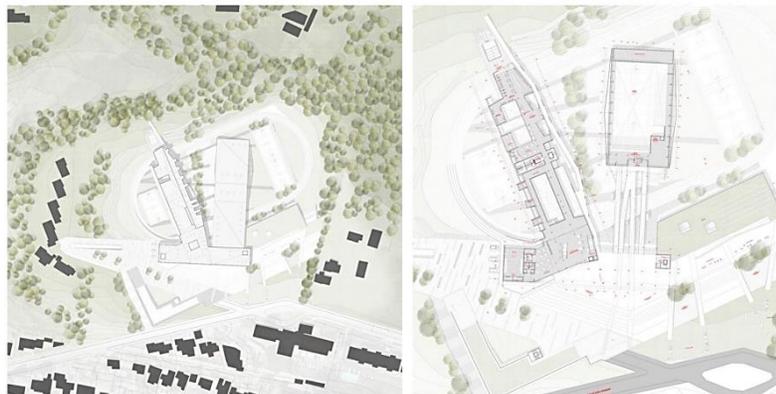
Centro Deportivo Planta Arquitectónica. Fuente Atlético Serena
